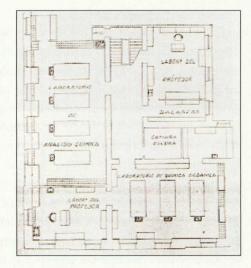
Planta primera del laboratorio de la Facultad de CC
